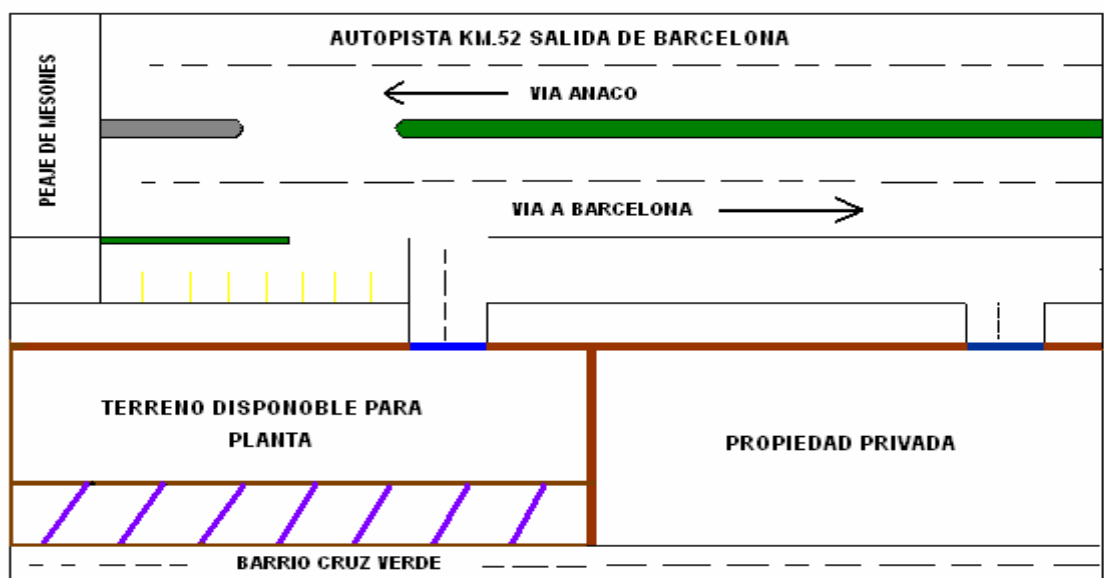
Layout de la parcela escogida para la construcción de la planta de solventes acrílicos
